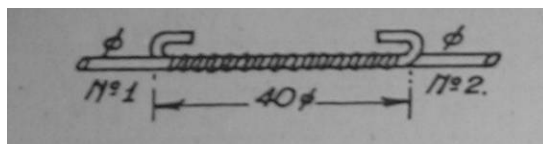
Detalle de solape de armado según la Norma de 1941.
